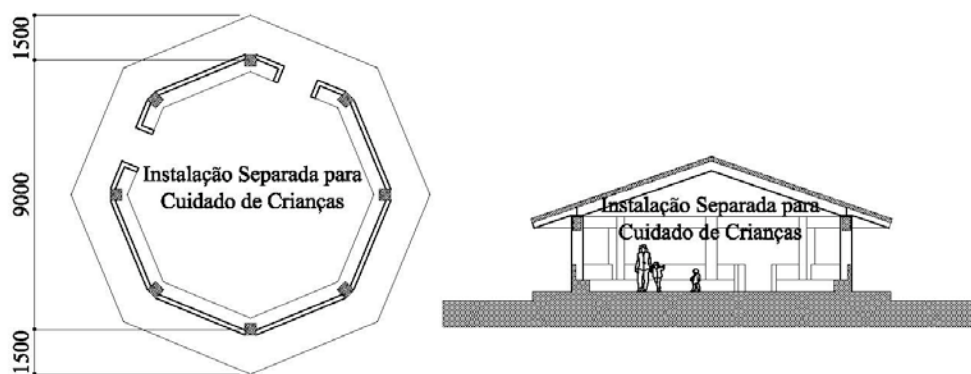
Plano da Instalação Separada para Cuidado de Crianças
